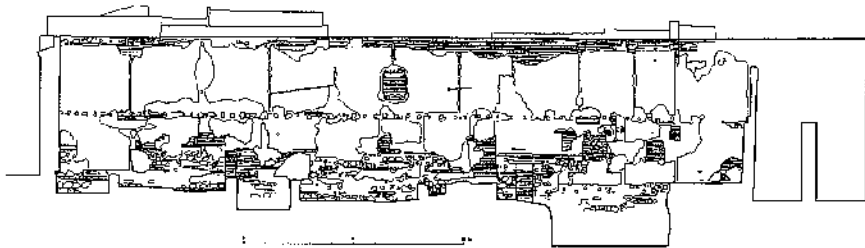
Alzado interior del muro medianero del lado oeste.
